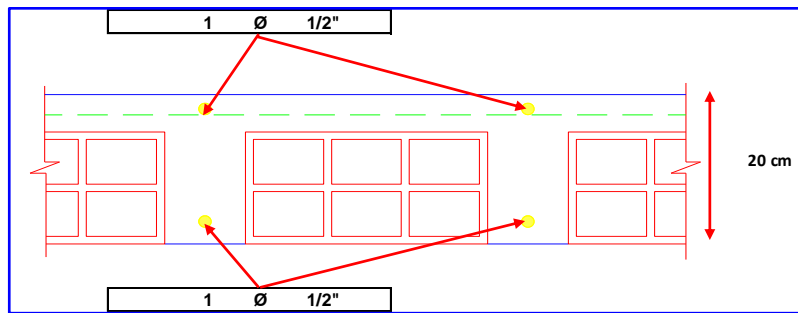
Detalle del Acero en Vigueta del Módulo A1
